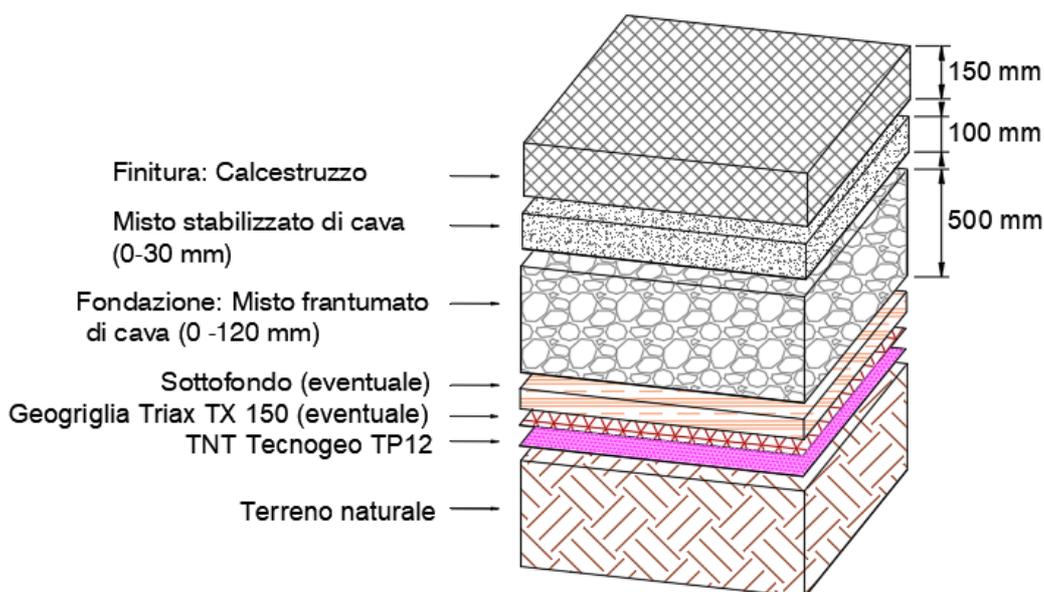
Tipico pacchetto stradale di Progetto – tratti a forte pendenza
